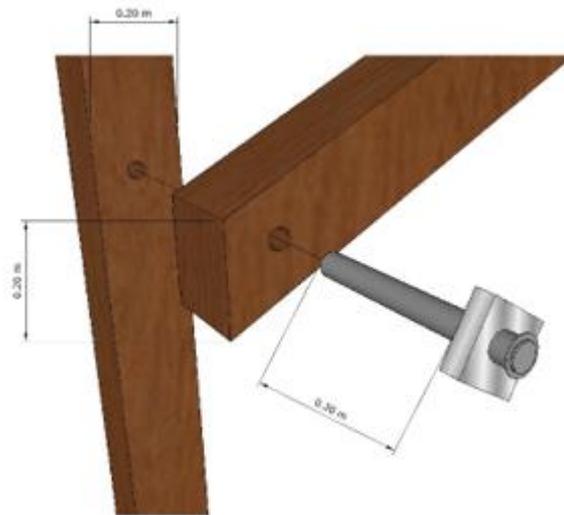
82* Detail D pada sambungan kepala bangunan pada zona I
